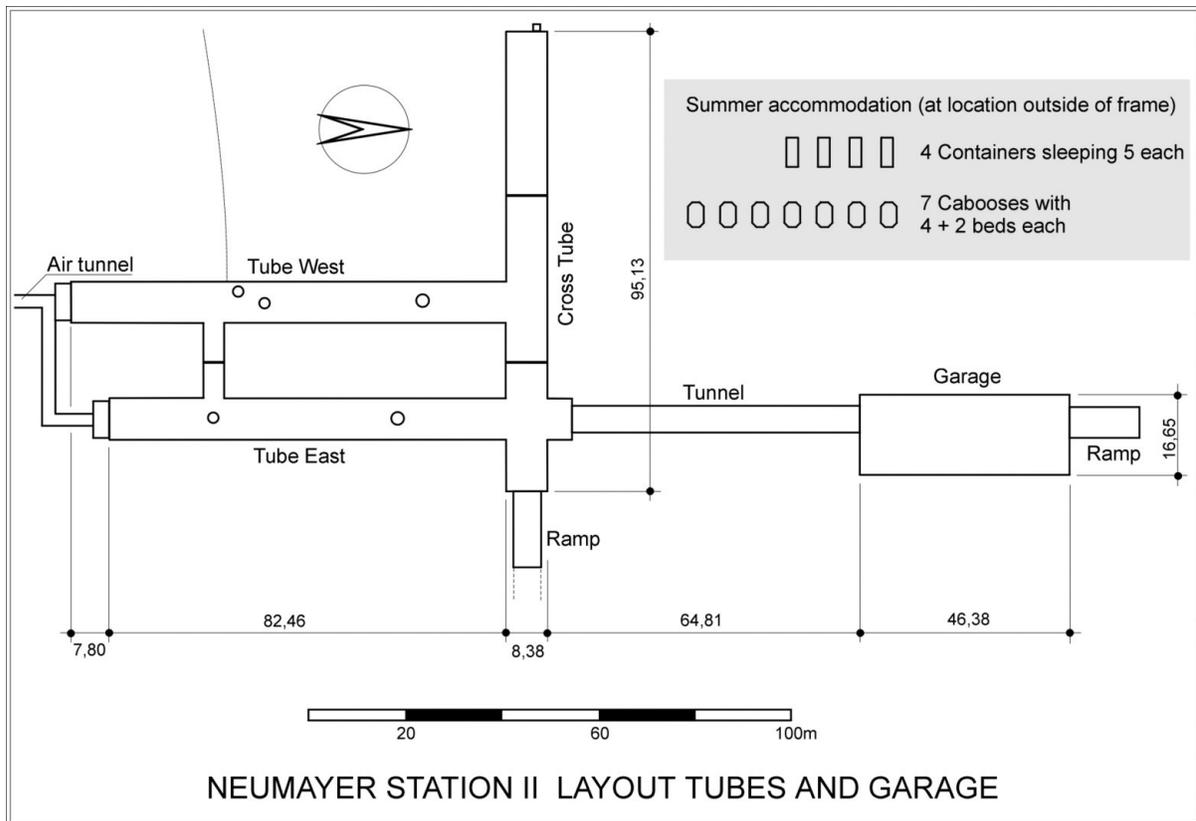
Neumayer-Station II Lageplan mit Garagengebäude
